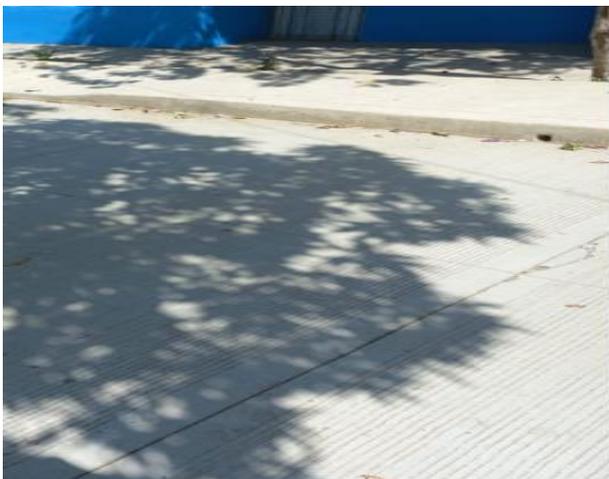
Losa con corte superficial longitudinal y transversal desde K0+000 hasta K0+131 y empozamiento de agua en losas entre K0+070 y K0+100.
